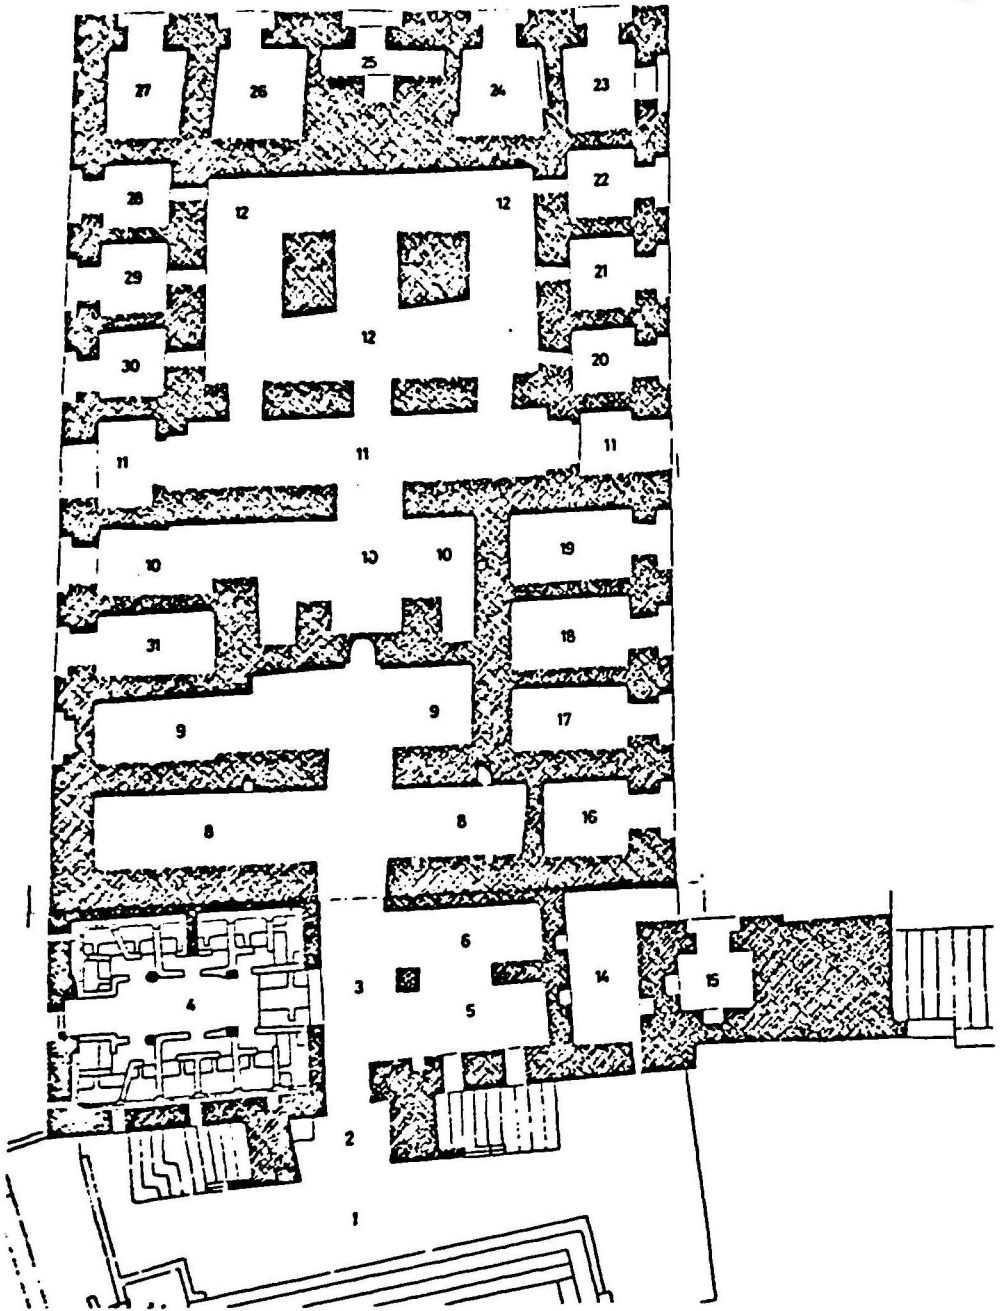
مسقط أفقي لمدرسة السلطان حسن بالقاهرة
